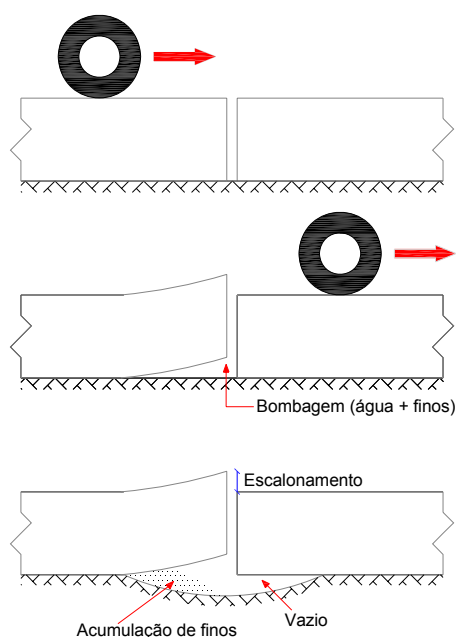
Mecanismos de erosão da fundação em juntas de lajes de betão simples
